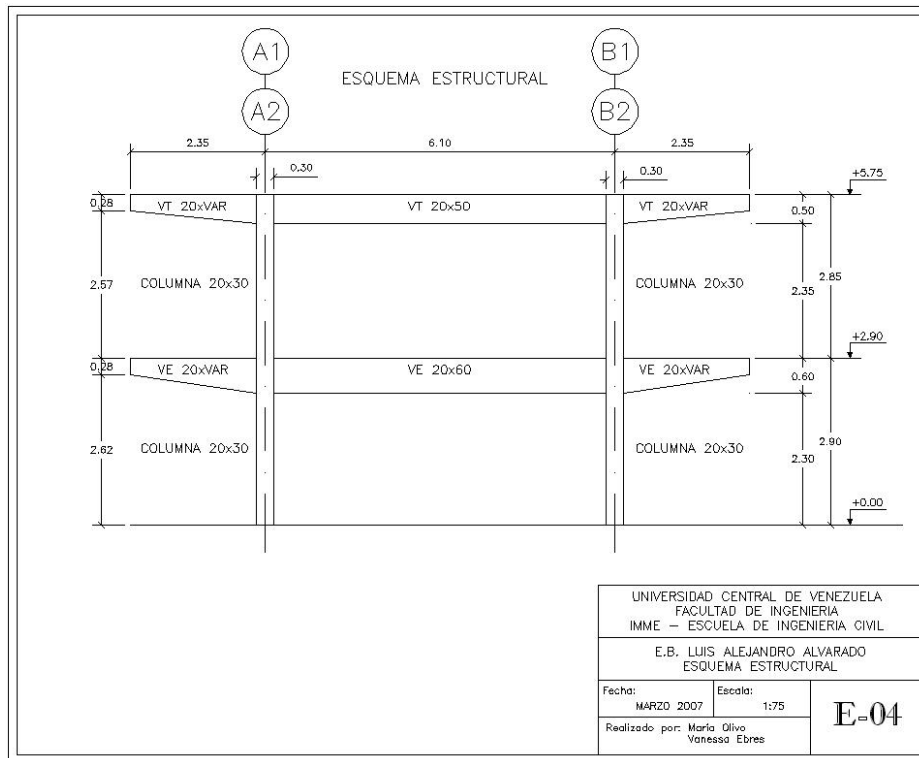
Esquema Estructural de un Alzado Típico.
